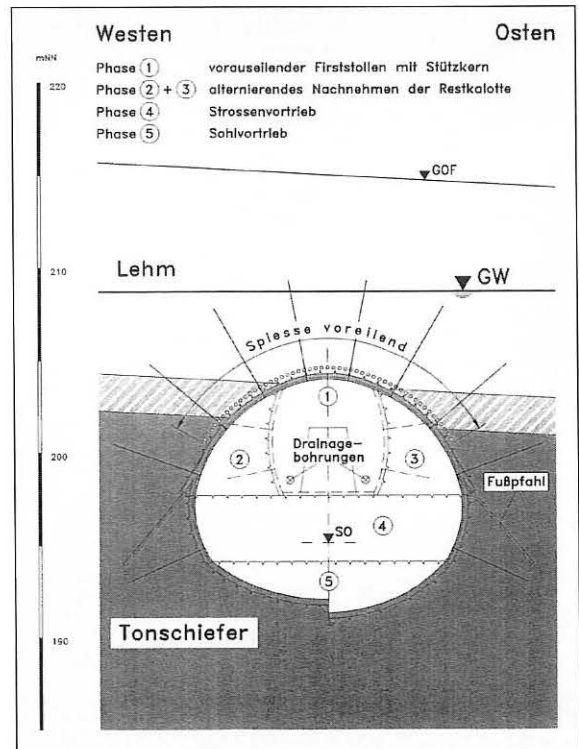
Tunnel Schulwald, Firststollenbauweise, Querschnitt
